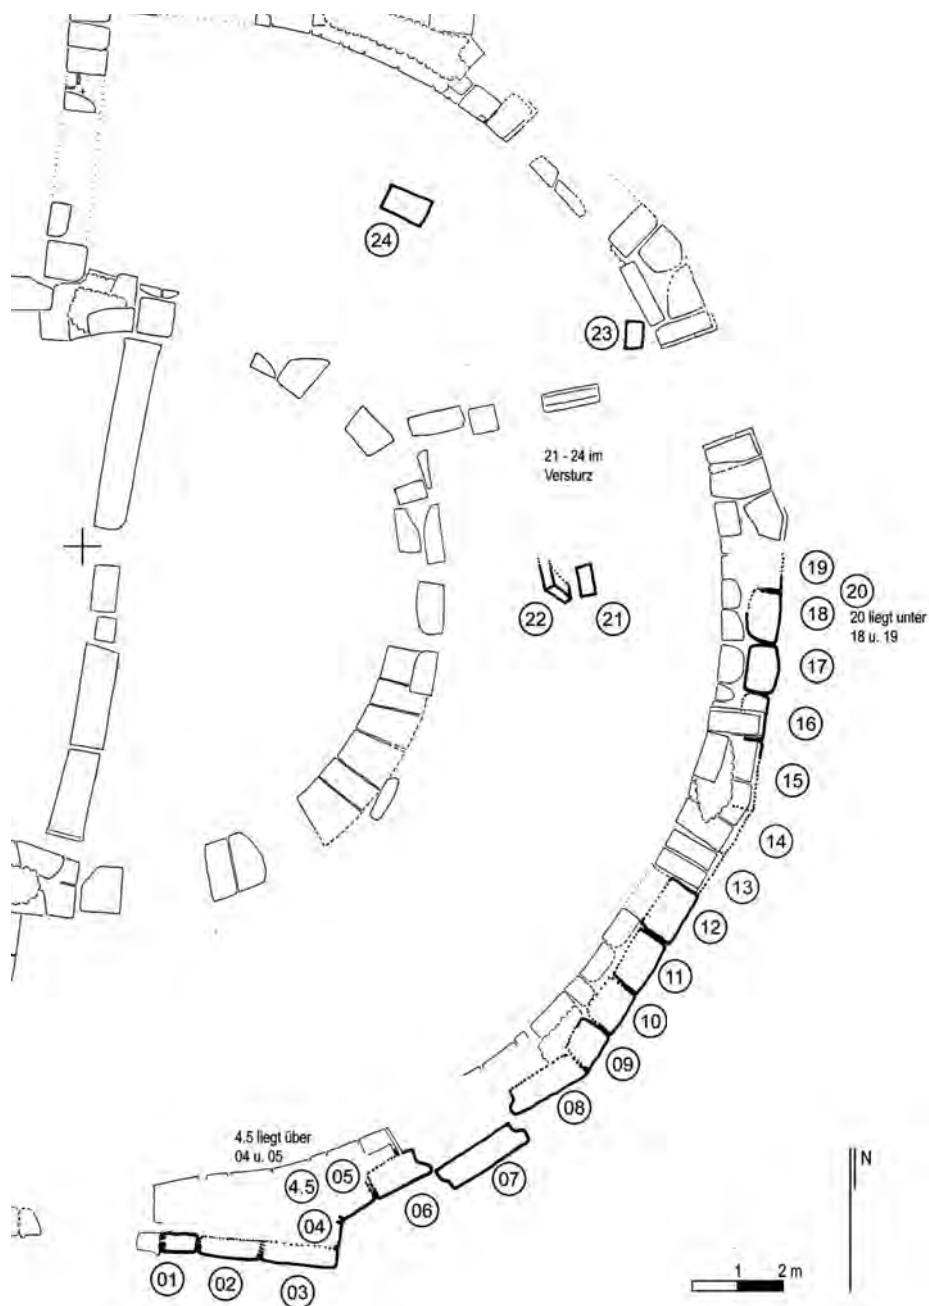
Grundriss der Apsis. Die Nummern bezeichnen die Architravblöcke
